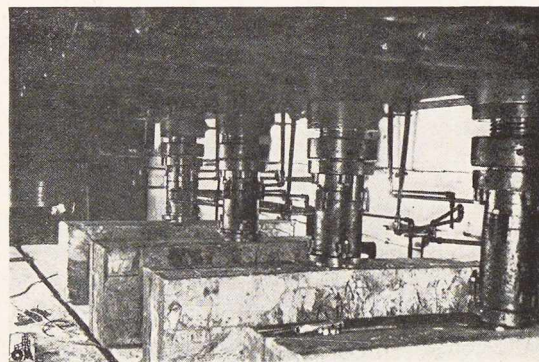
Essai d'un tablier en poutrelles enrobées.
